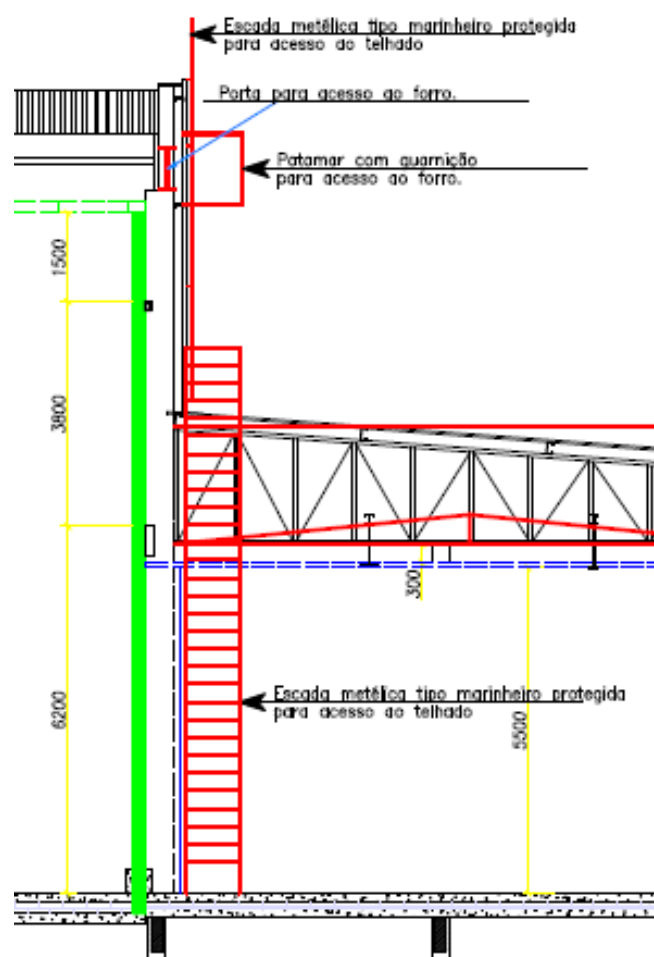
Solução de PPS para definição de áreas de acesso ao forro e ao telhado por escada fixa
